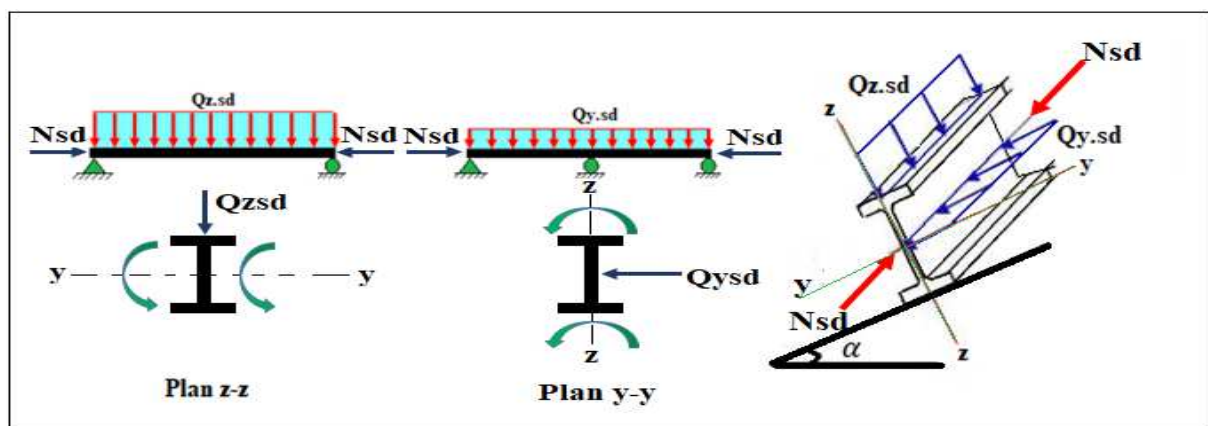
Montants de la poutre au vent en flexion sous les différents plans de chargement
